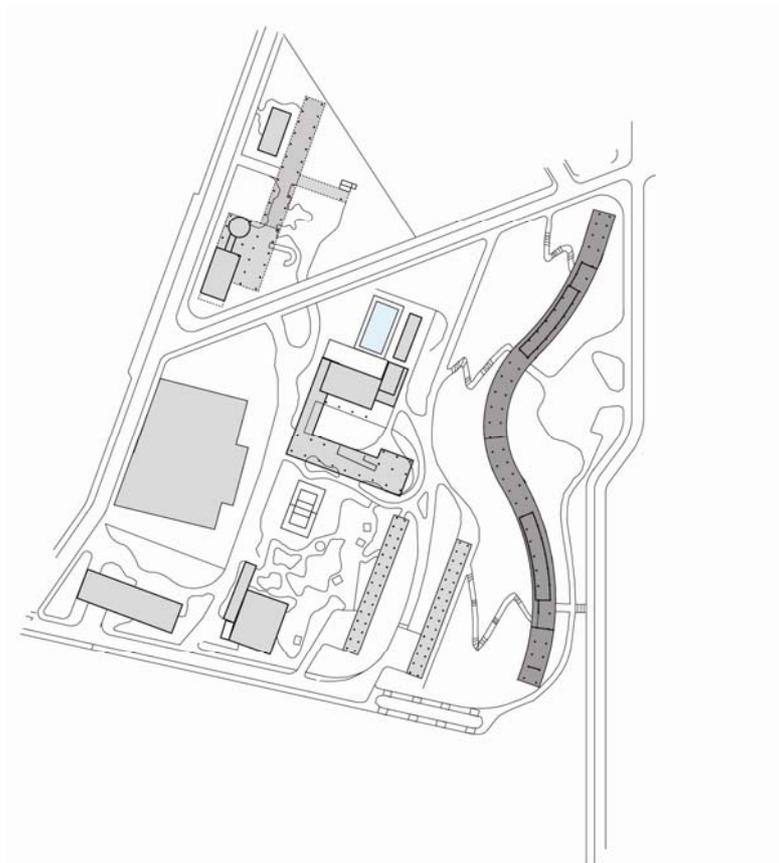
Planta de situação Conjunto Pedregulho, Affonso Reidy. 1950-1952.
